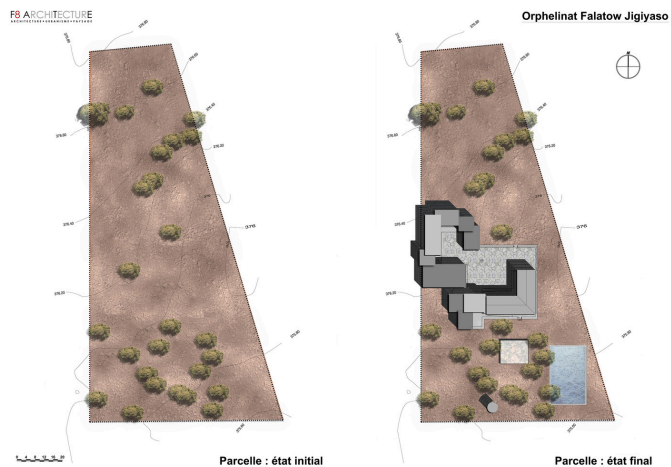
Planta de techos - Orfanato Falatow Jigiya
